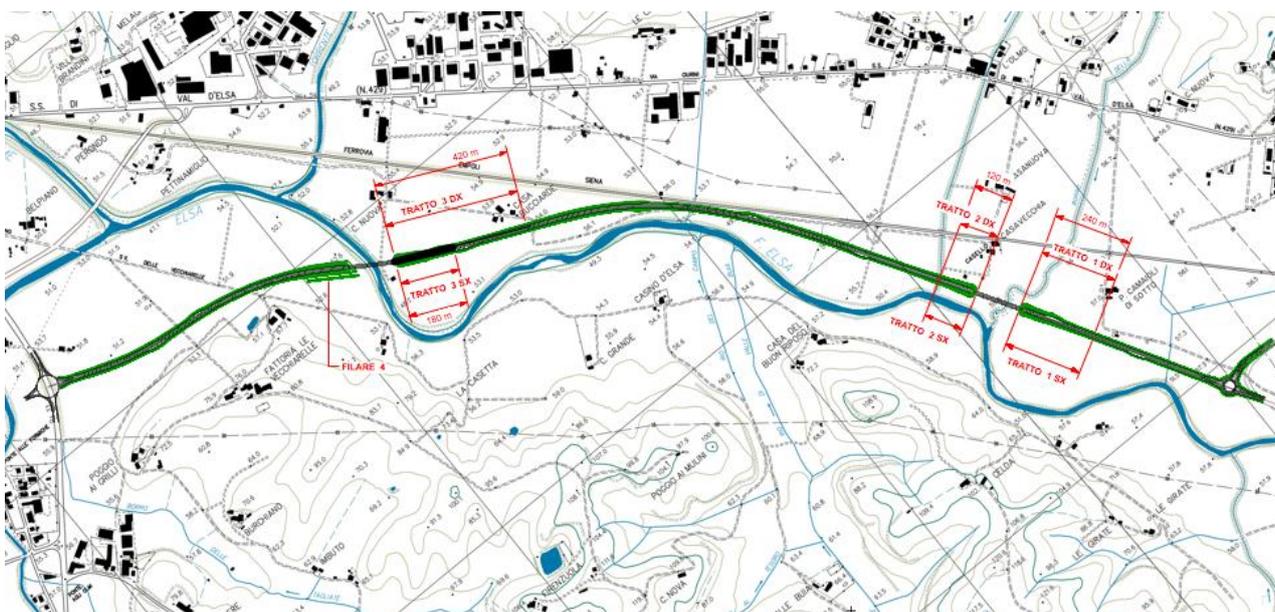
Planimetria di posizionamento delle opere di mitigazione a verde sui rilevati stradali.
